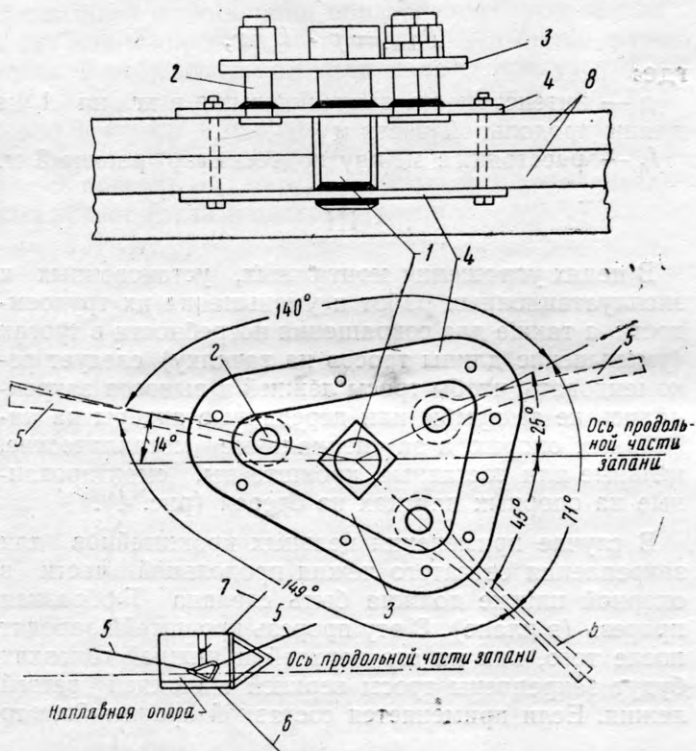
Схема крепления тросов на верхней головке кронштейна:
